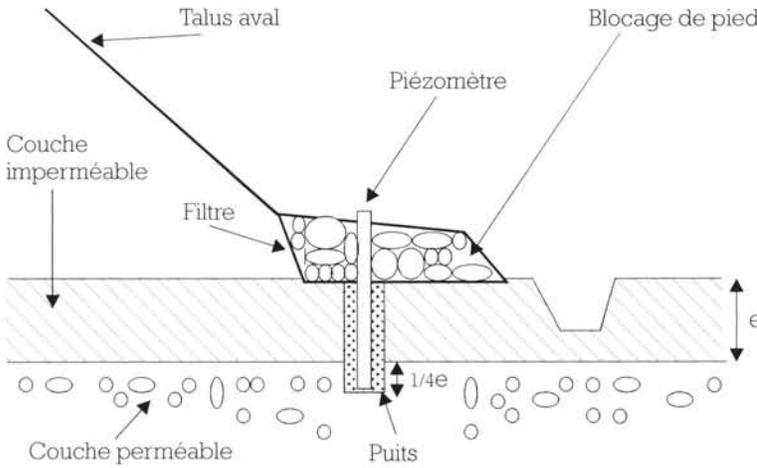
Soulagement des sous-pressions par puits aval prolongés dans la couche perméable.
